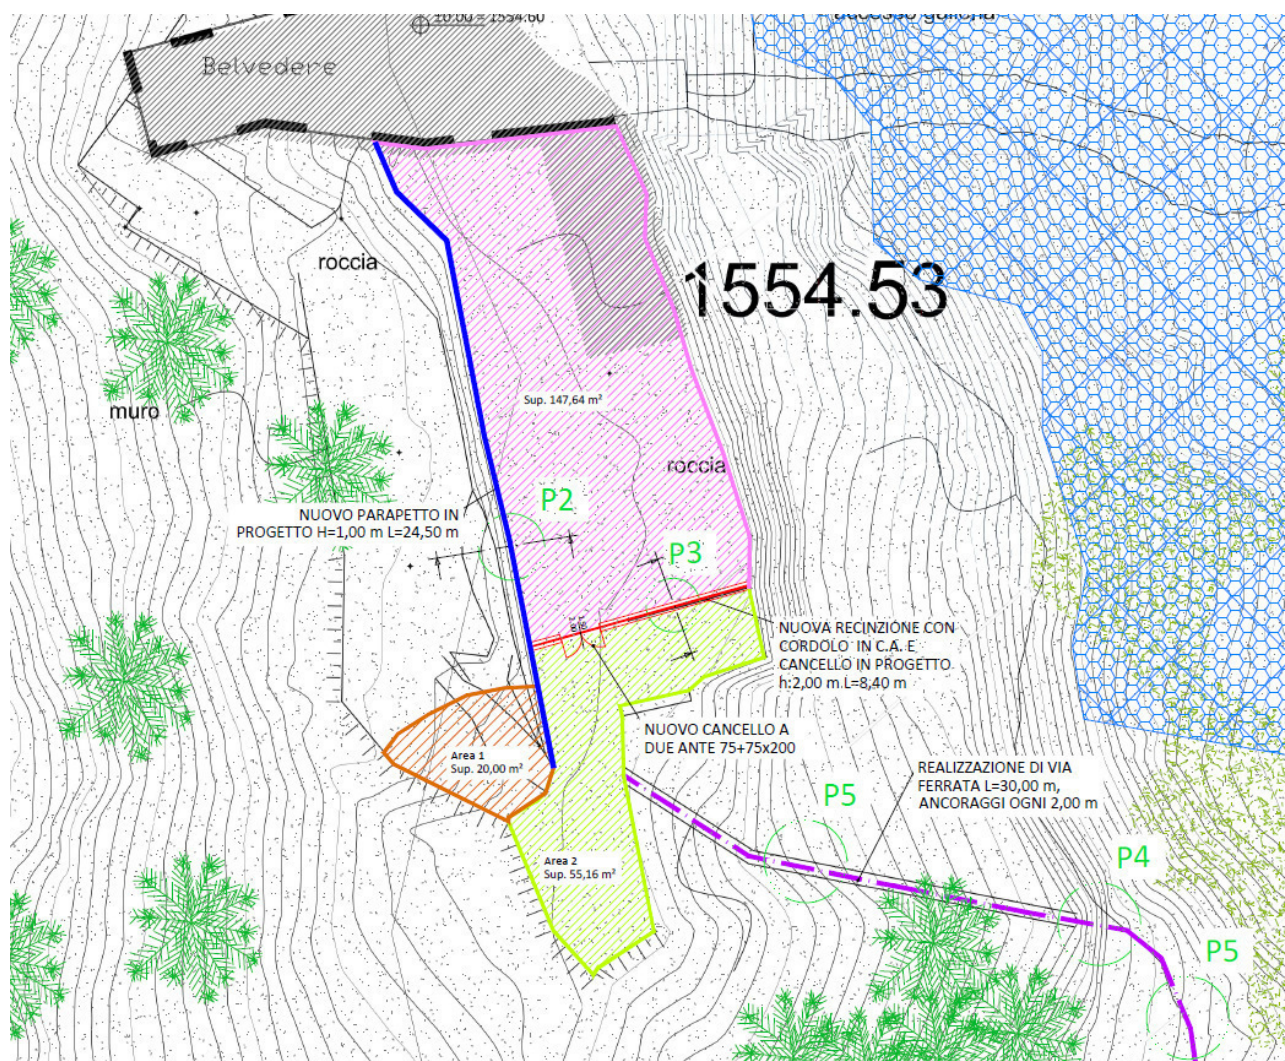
Estratto di Tav.04 – Planimetria aree esterne
